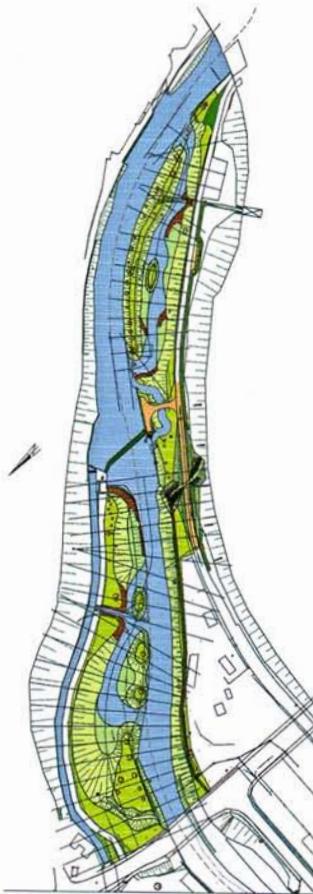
Übersichtsplan – Technische Bauwerke/Profilausbau/Quelle: IB Bauer – Tiefbauplanung
